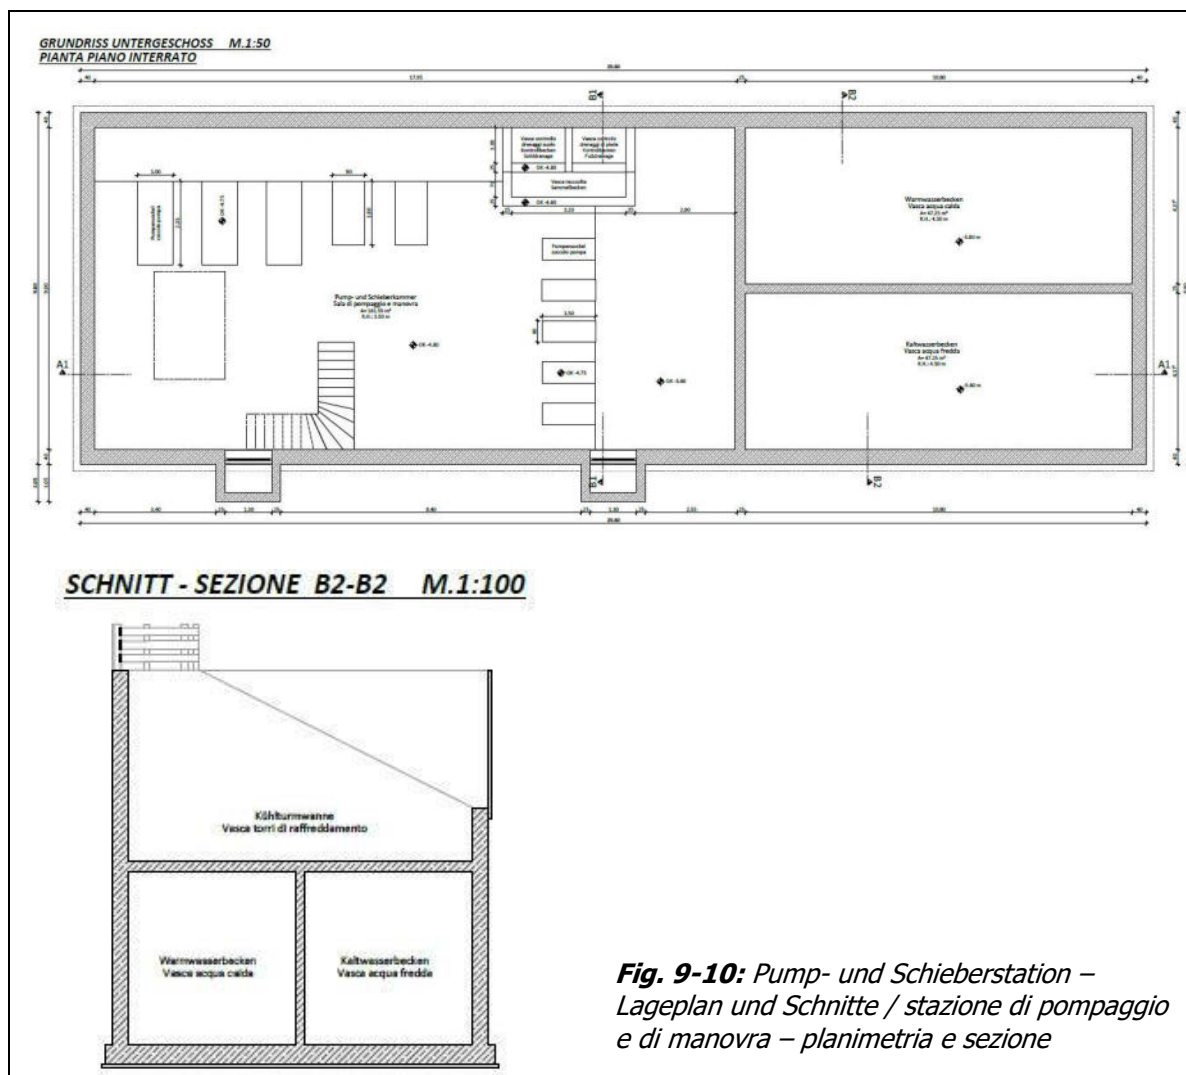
Pump- und Schieberstation – Lageplan und Schnitte / stazione di pompaggio e di manovra – planimetria e sezione
